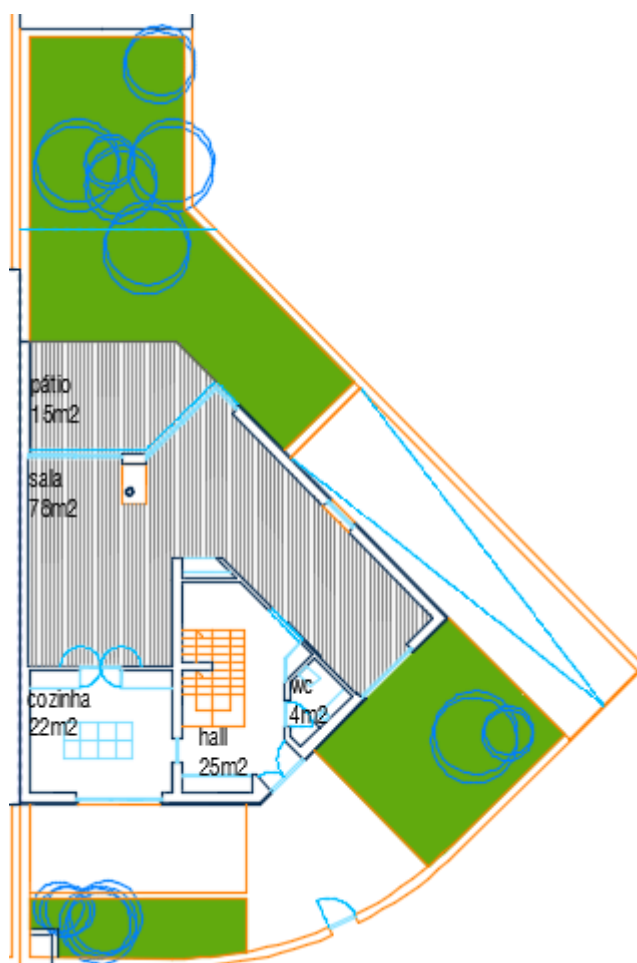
Planta do Rés-do-Chão (Arquitetura).
